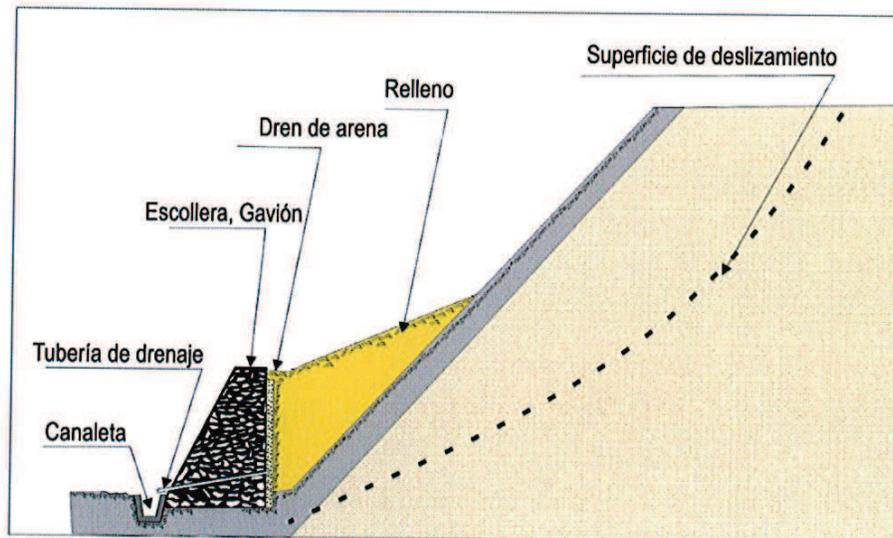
Muro permeable al pie del talud de una zona con deslizamiento.
